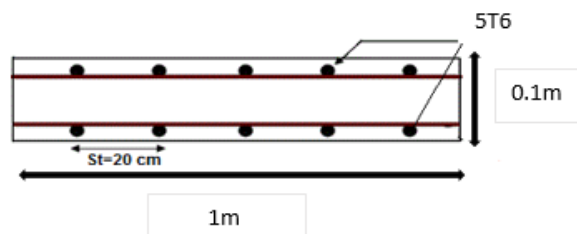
schéma de ferrailage de l'acrotère longitudinal.
